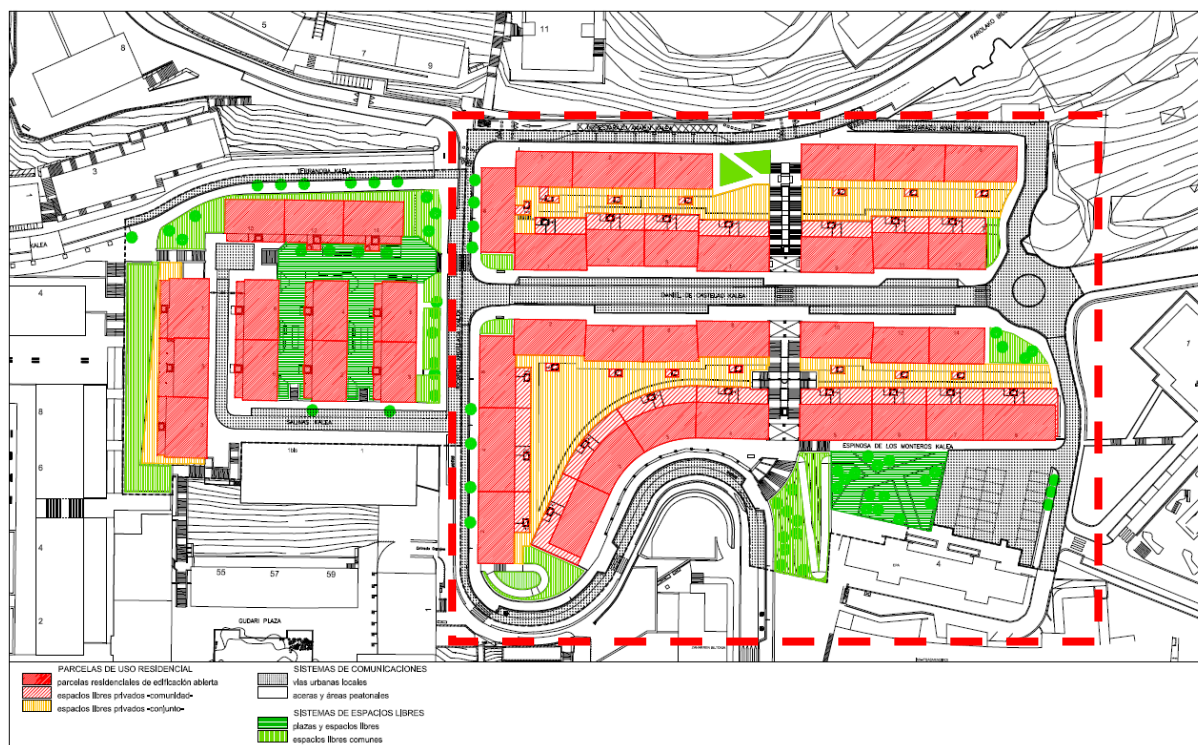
Ordenación pormenorizada de Poblado (dcha). Fuente: Plano PRO.11-2 del Plan Especial
